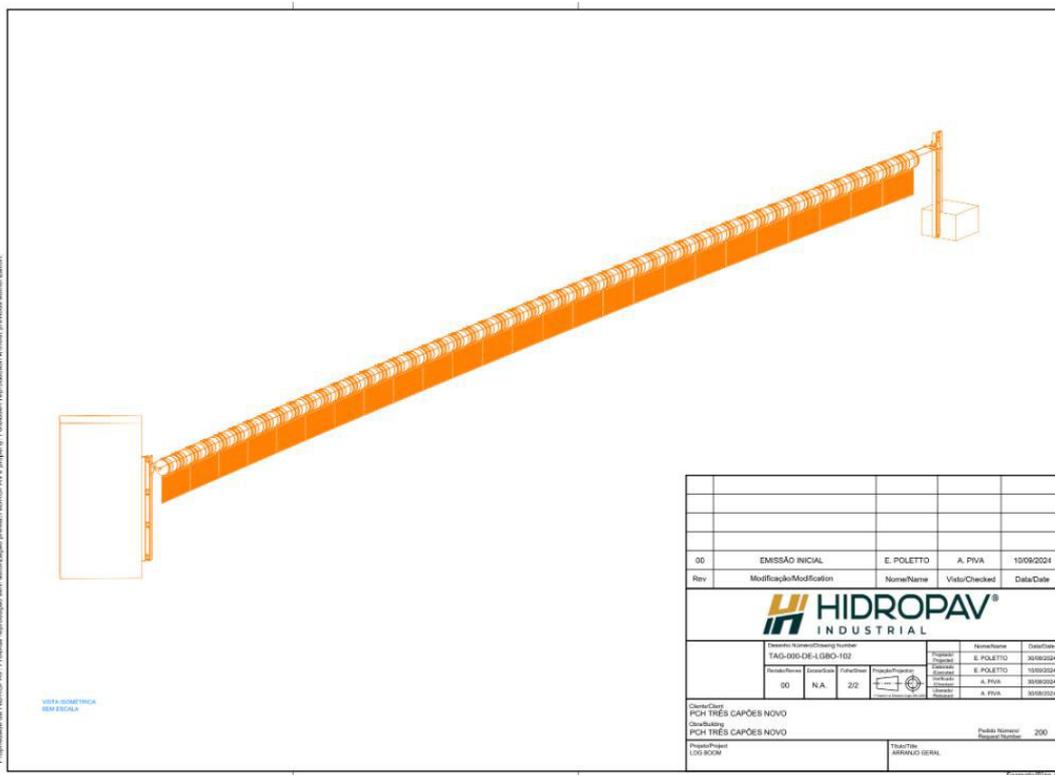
ARRANJO GERAL DO LOG-BOOM PREVIAMENTE À INSTALAÇÃO NA PCH TRÊS CAPÕES NOVO.
